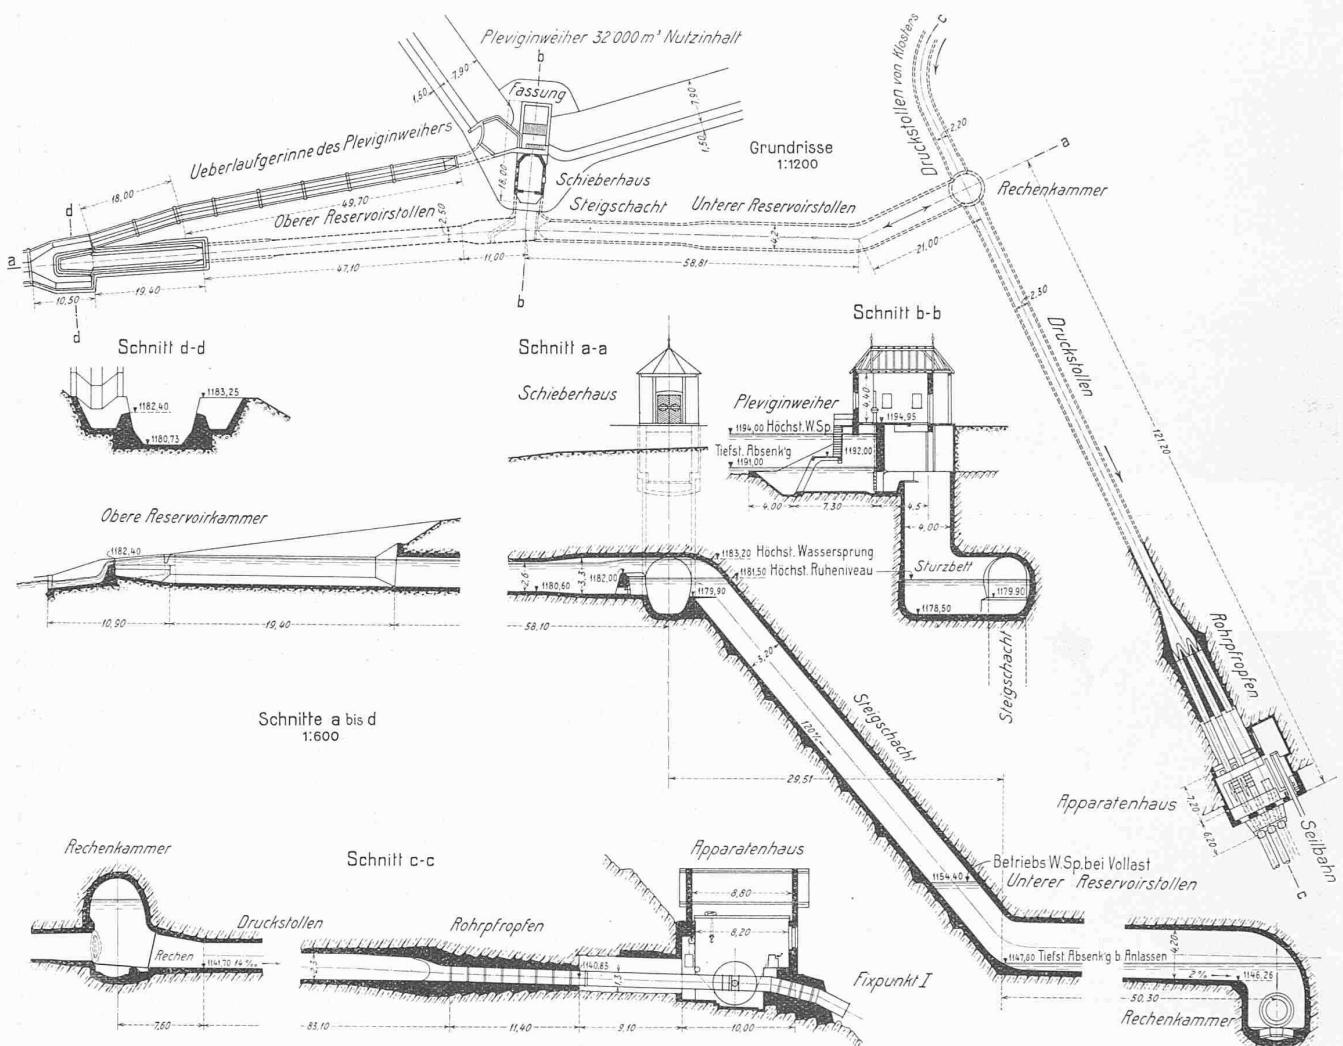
Das Wasserschloss samt Anschluss des Ausgleichsweihers Plevigin, links oben der Ueberlauf. — Grundriss 1:1200, Schnitte 1:600.
